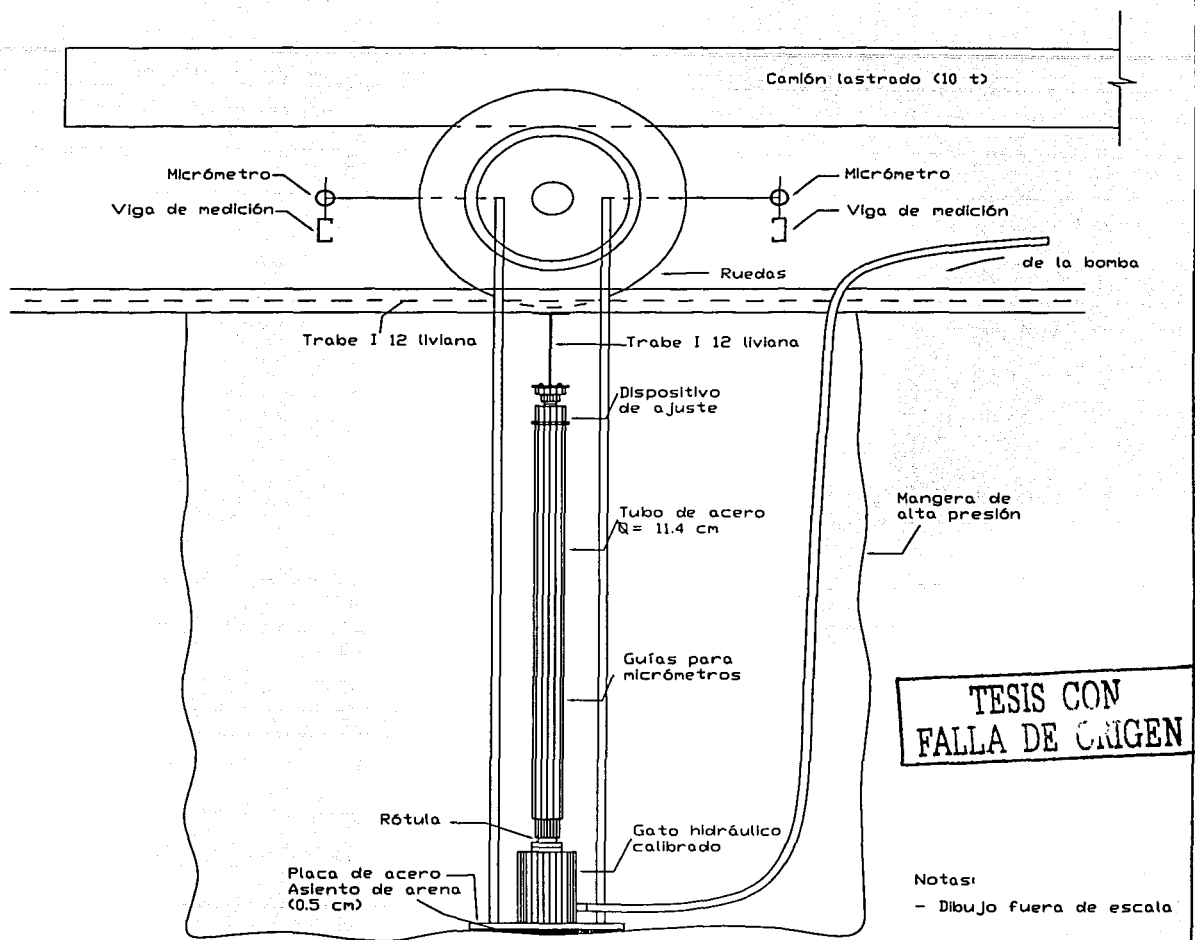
DISPOSITIVO UTILIZADO EN LAS PRUEBAS DE PLACA VERTICALES
